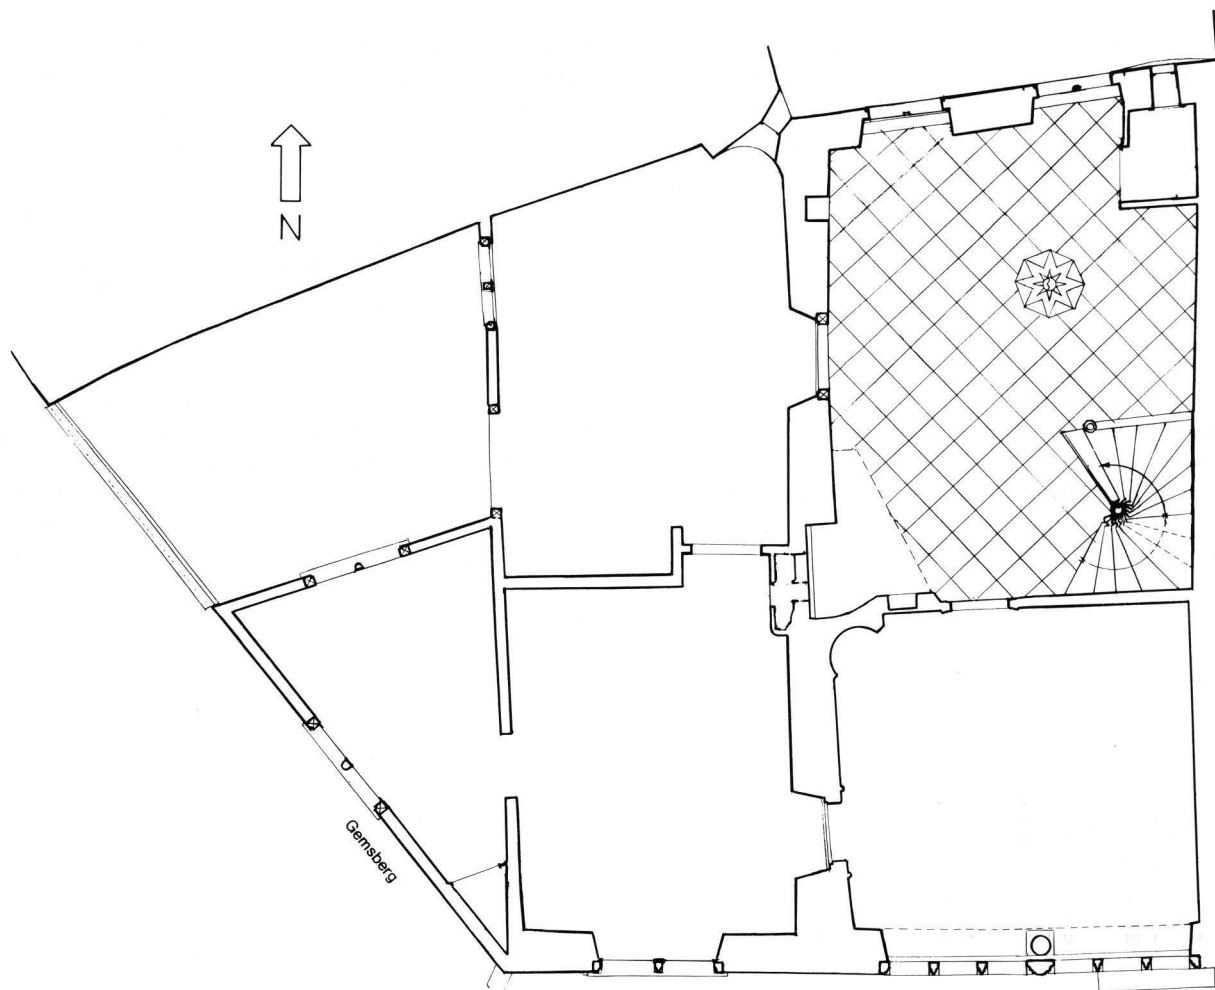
Gernsbach 7. Grundriss des ersten Stocks, Zustand 1998. – Zeichnung: M. Merki (BaDpfl.). – Massstab 1:100.
